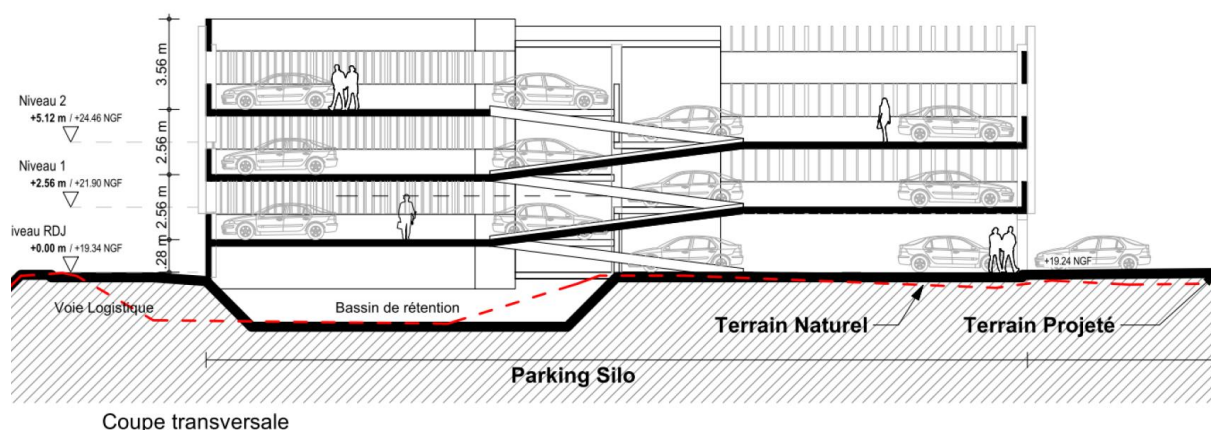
Plan en coupe du futur parking Silo (source : Patriarche)
